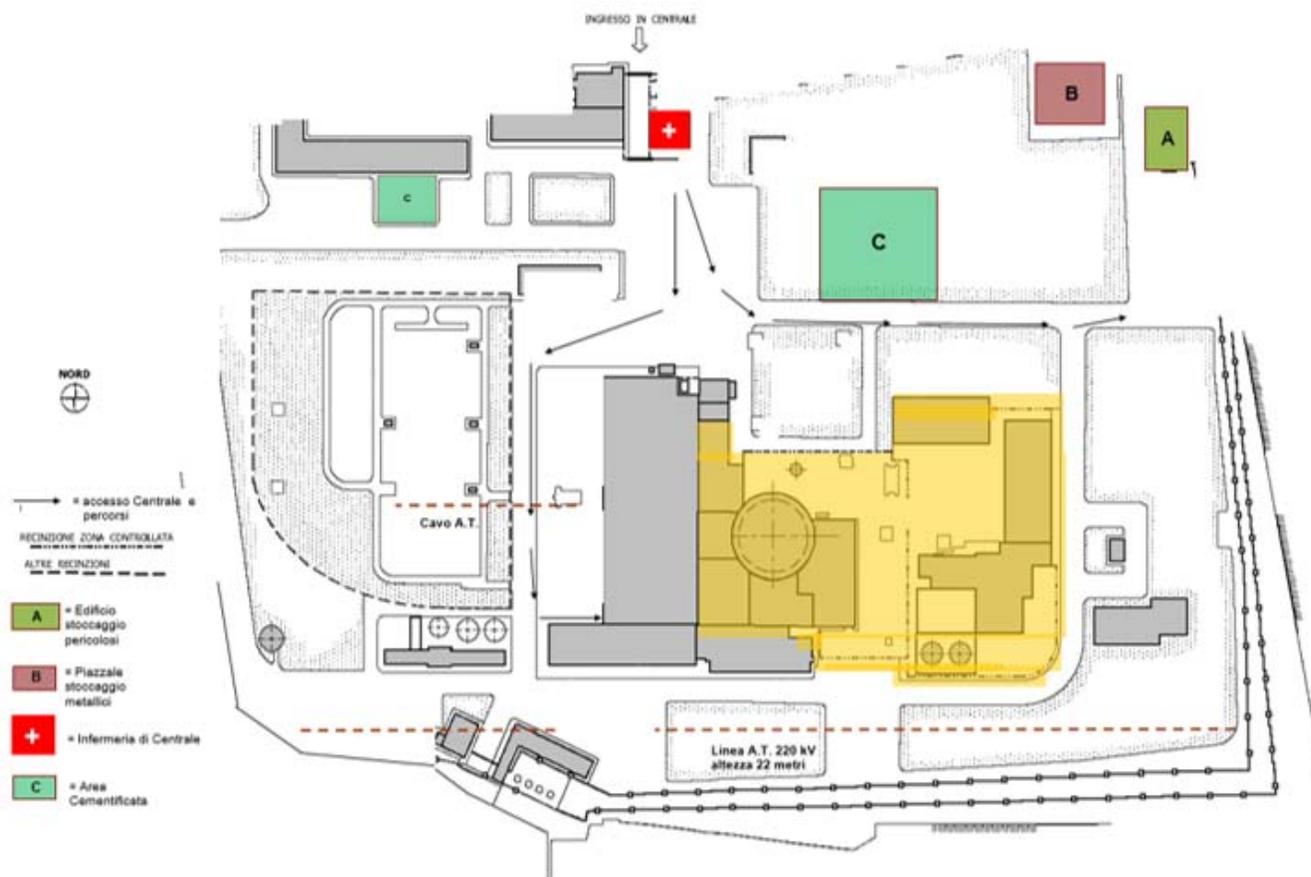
/2 - Planimetria del sito con ubicazione delle aree di stoccaggio
